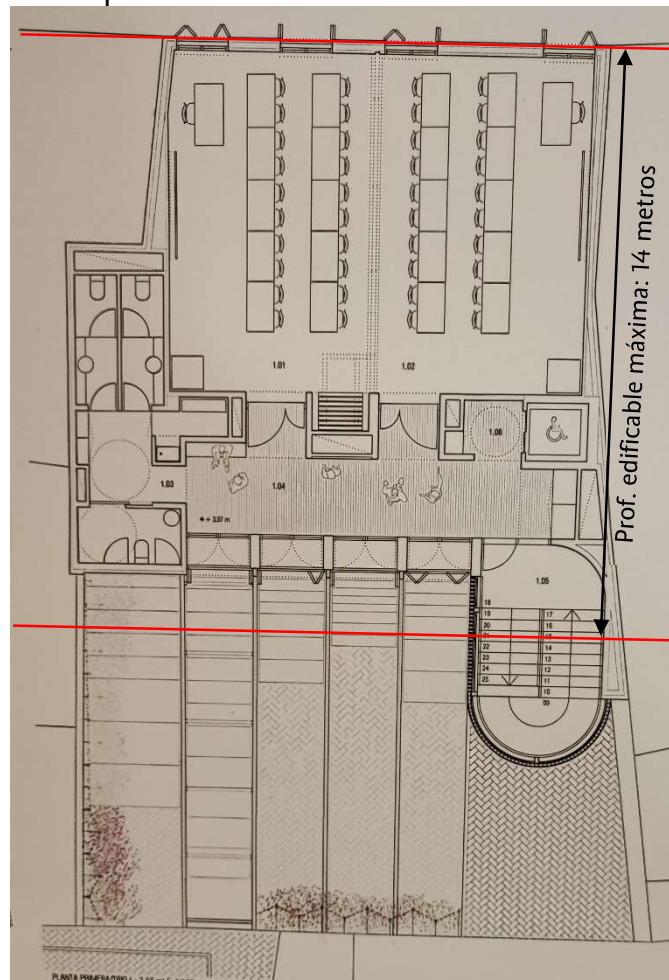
Detalle de la planta piso tipo en PLANTA PRIMERA TIPO (escala 1:100) en la lámina 1/2 de la documentación presentada por el licitador.
